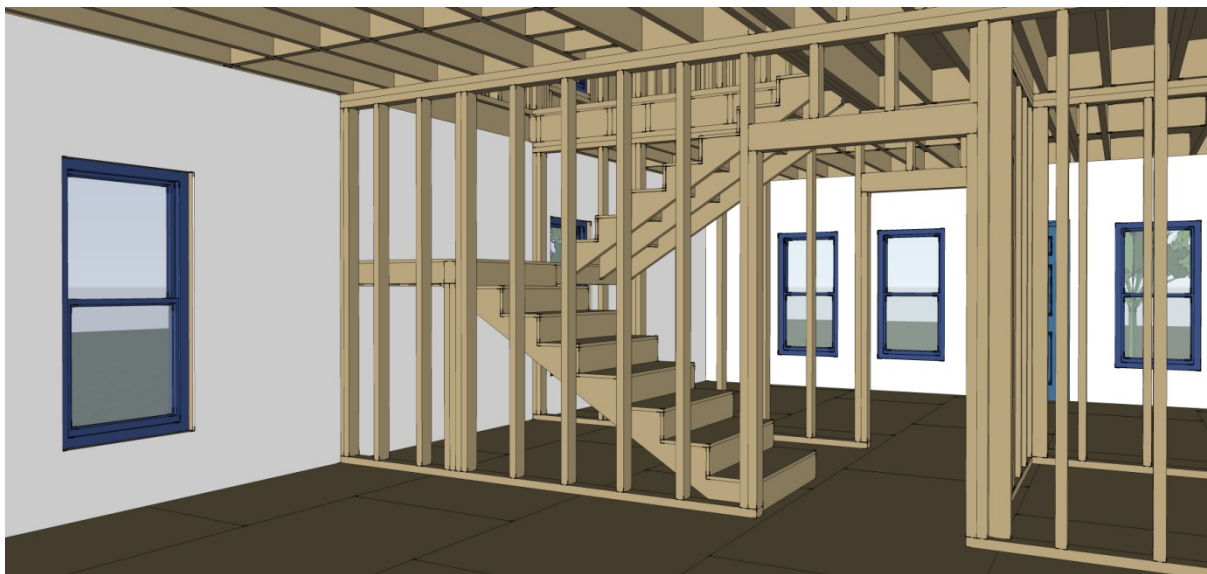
Preenchimento das caixas de ar entre prumos com isolamento térmico e forro das paredes exteriores com painéis de gesso cartonado.
